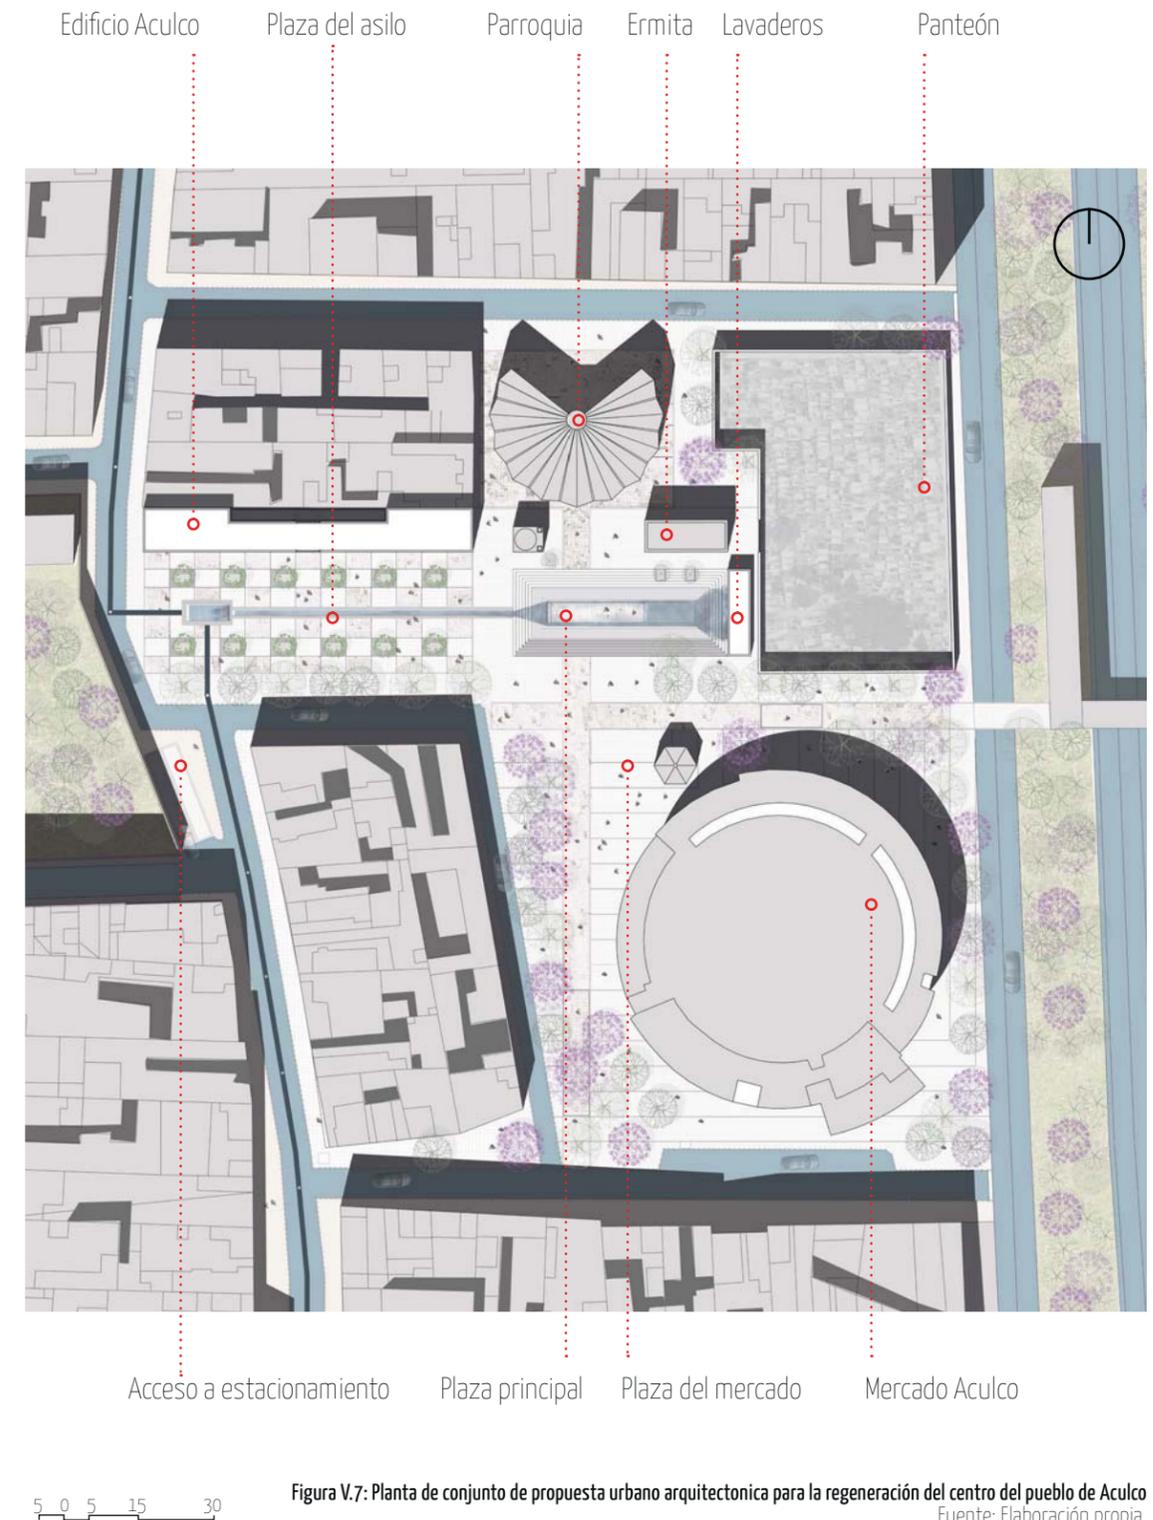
Planta de conjunto de propuesta urbano arquitectonica para la regeneración del centro del pueblo de Aculco
